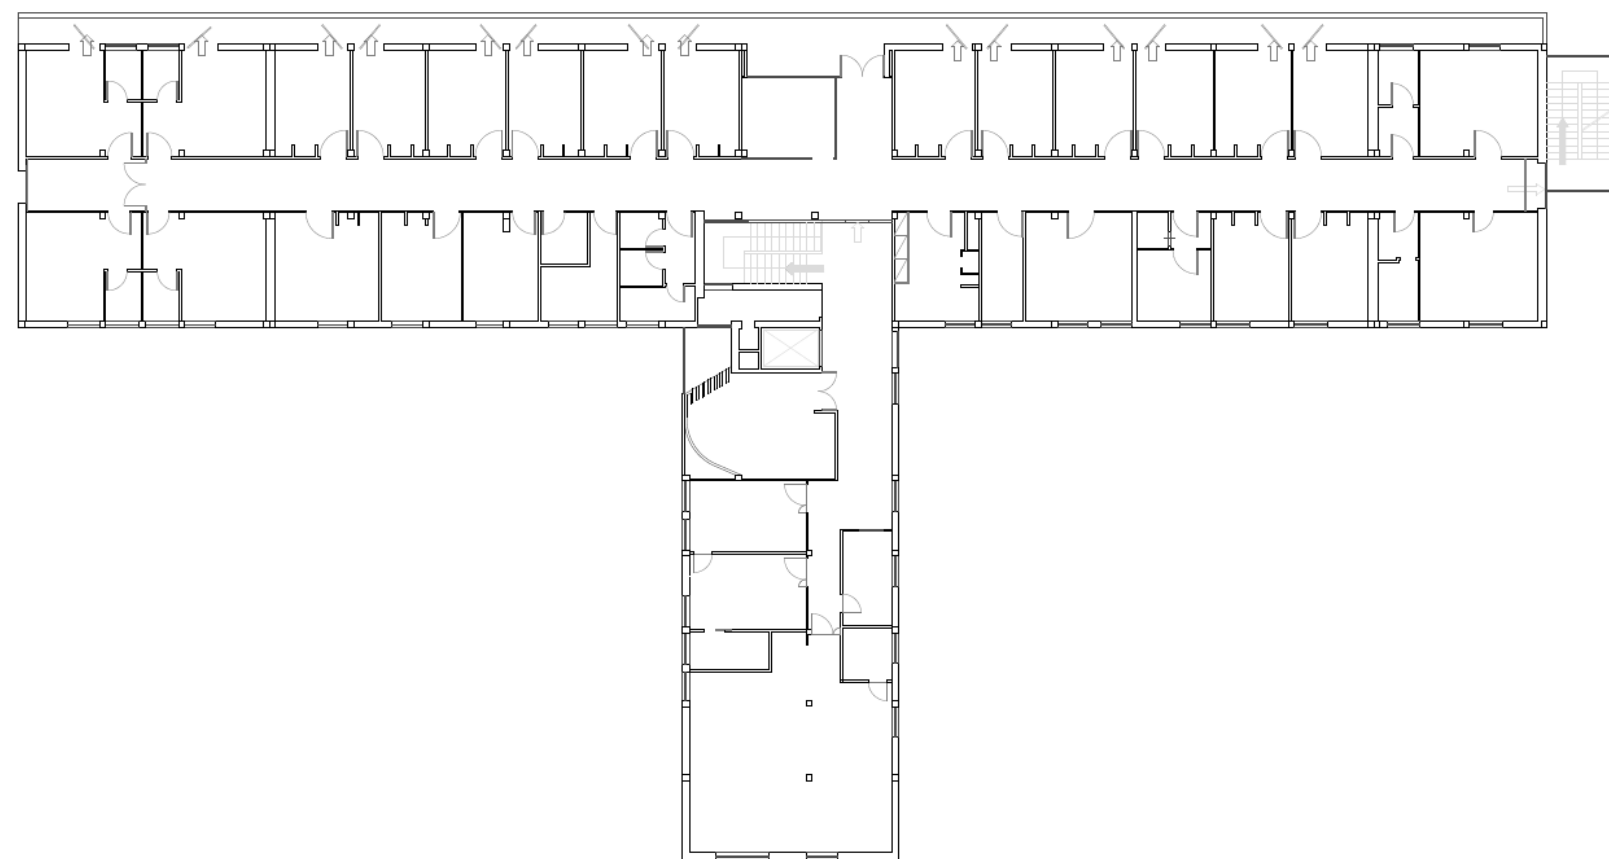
EX CLINICA BELVEDERE - PIANO PRIMO
